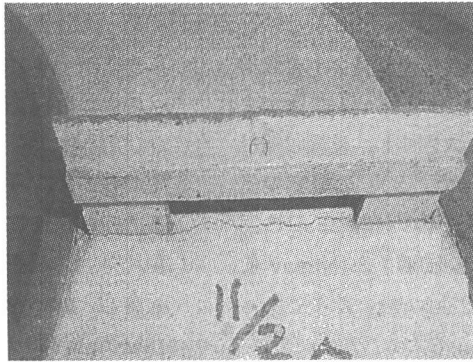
ひび割れ発生状況 (Aシリーズ)
